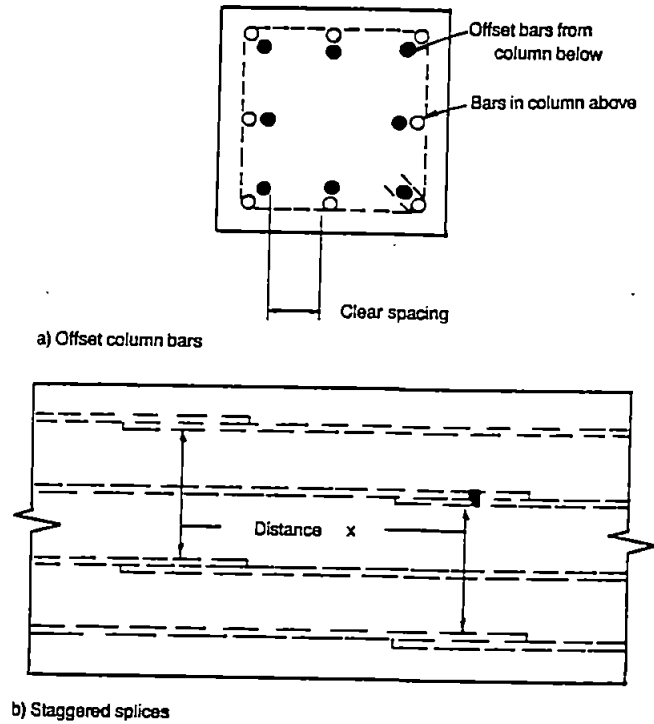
Espaciamiento libre de barras traslapadas.
